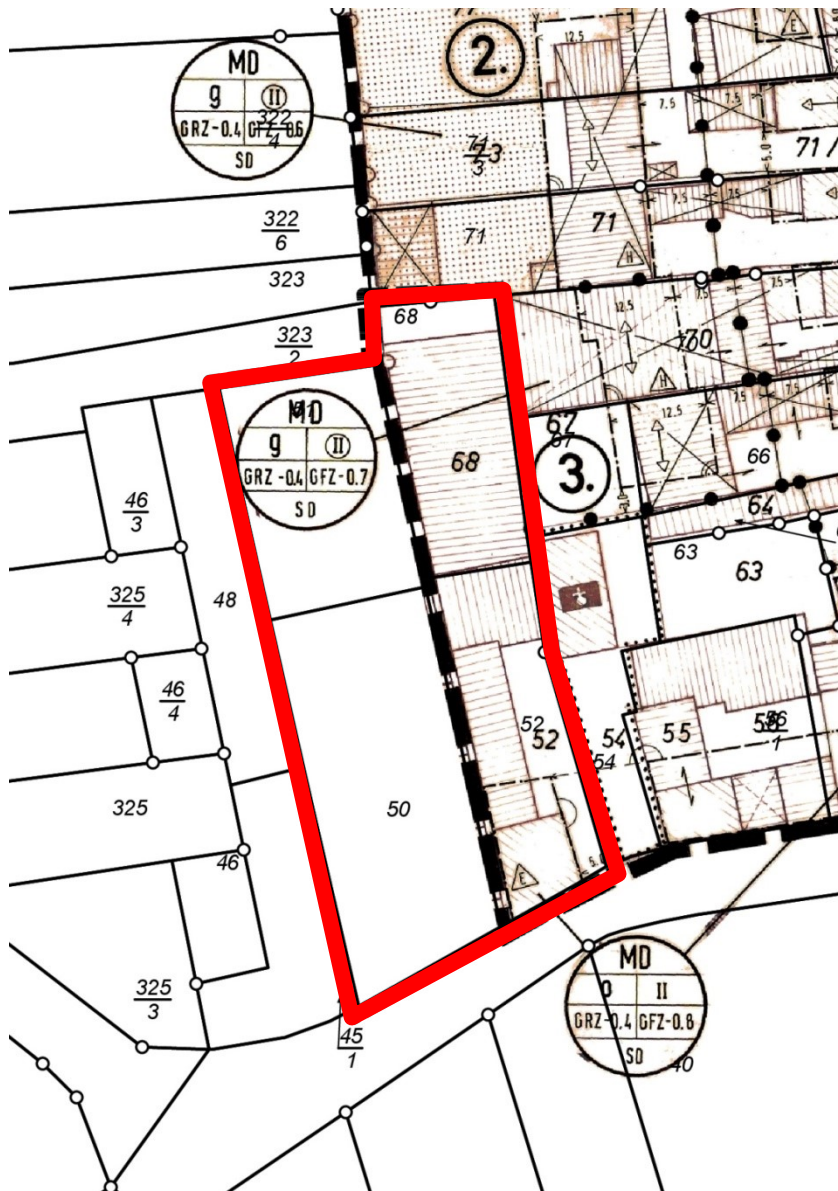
Auszug aus Bebauungsplan „Eppstein, Hintergasse“ mit Abgrenzung des Plangebiets o. M. ■ Plangebiet
